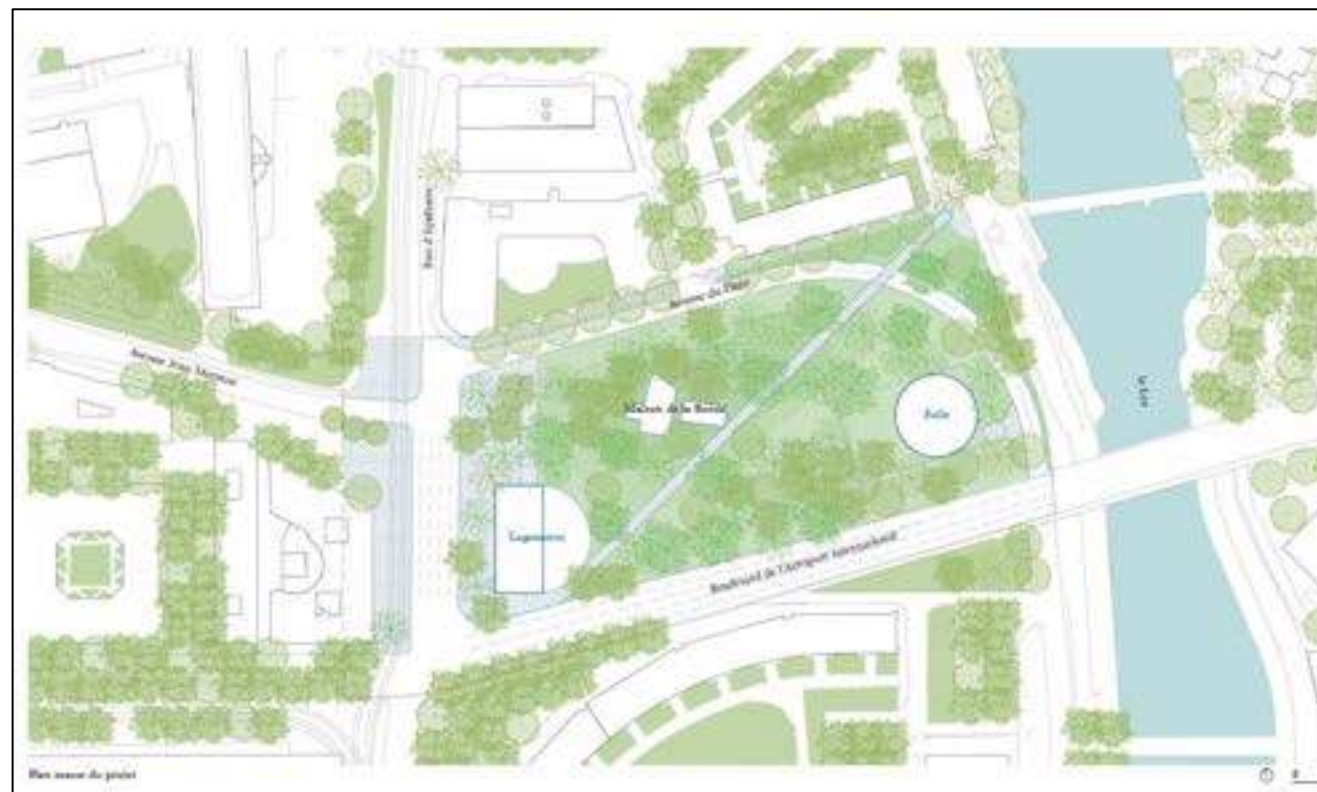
Secteur îlot de la maison de la poésie – Plan masse du projet
